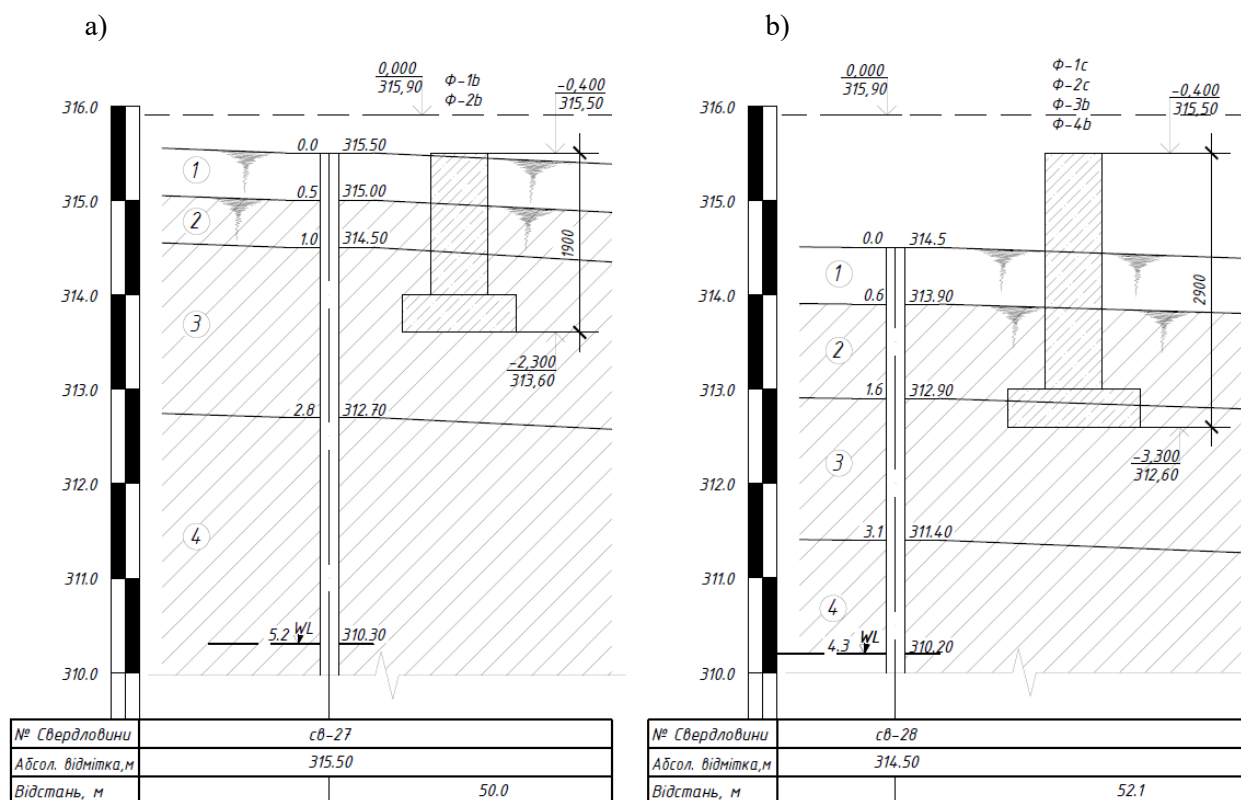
Фрагменти інженерно-геологічних розрізів ділянки будівництва та посадка фундаментів: а) колонка свердловини св.-27; б) колонка свердловини св.-28.
